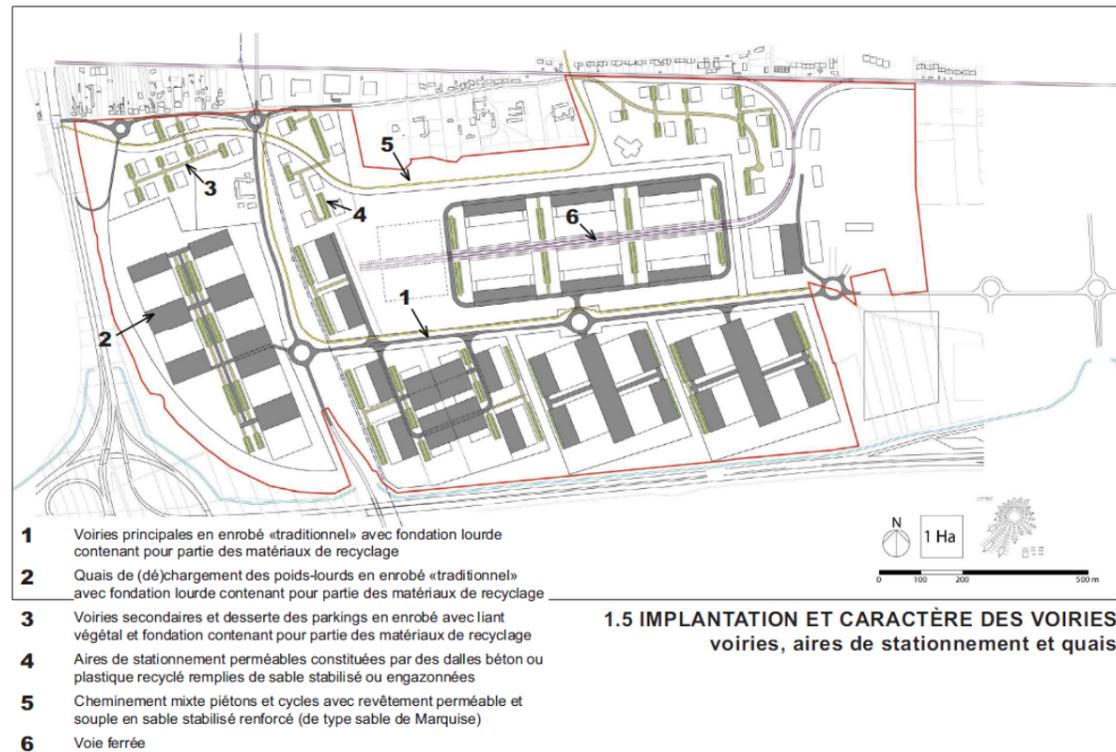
3 : Plan masse de la ZAC de la Turquerie (Source : Cap Calais – V2R, 2009)
